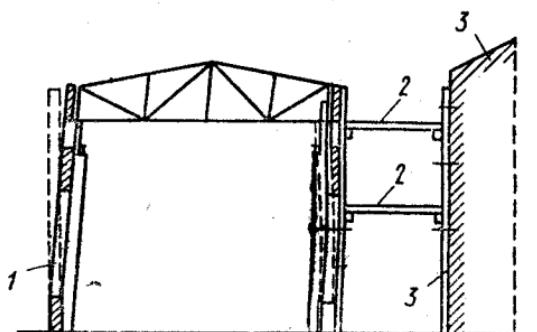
Крепление наклонившейся стены к стенам устойчивых зданий:
